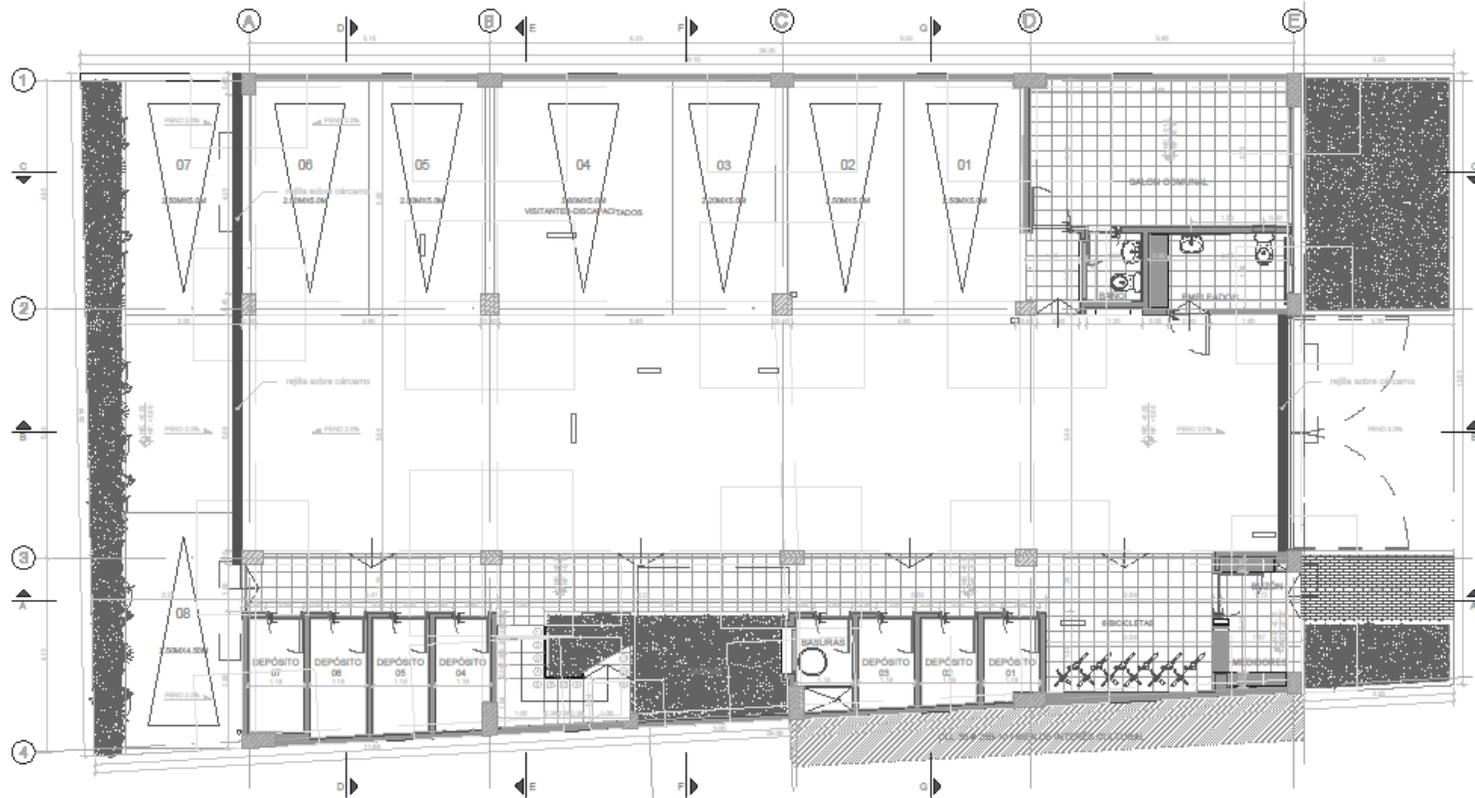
Plano arquitectónico segundo piso Fuente Arq. Alexander Palacio.
